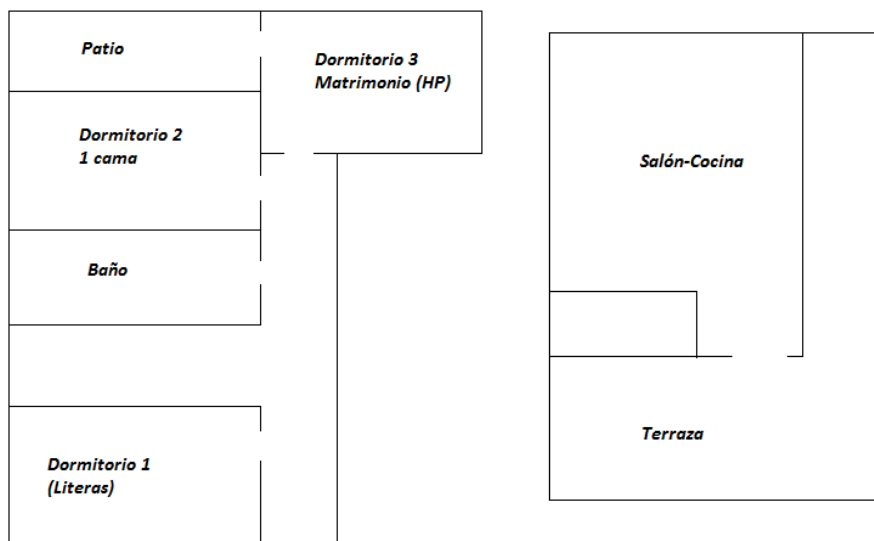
Esquema de la distribución interior del edificio 1 (planta alta y baja)
